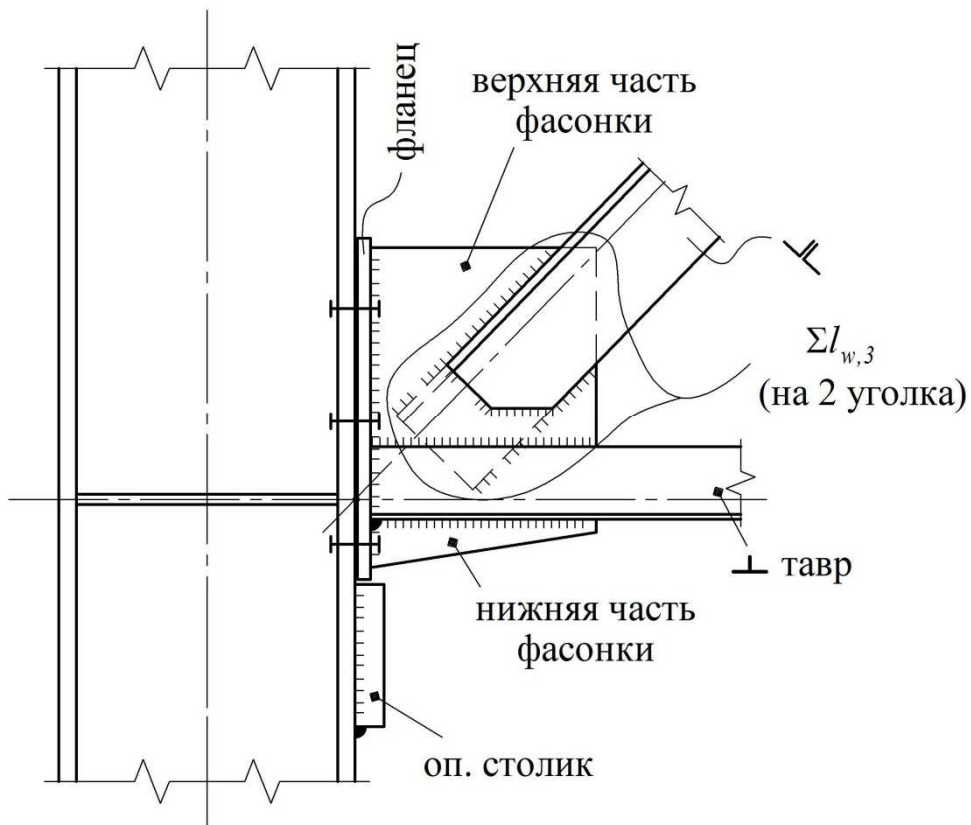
Вариант опорного узла стропильной фермы с нижним поясом из тавра и опорного раскоса из парных уголков
